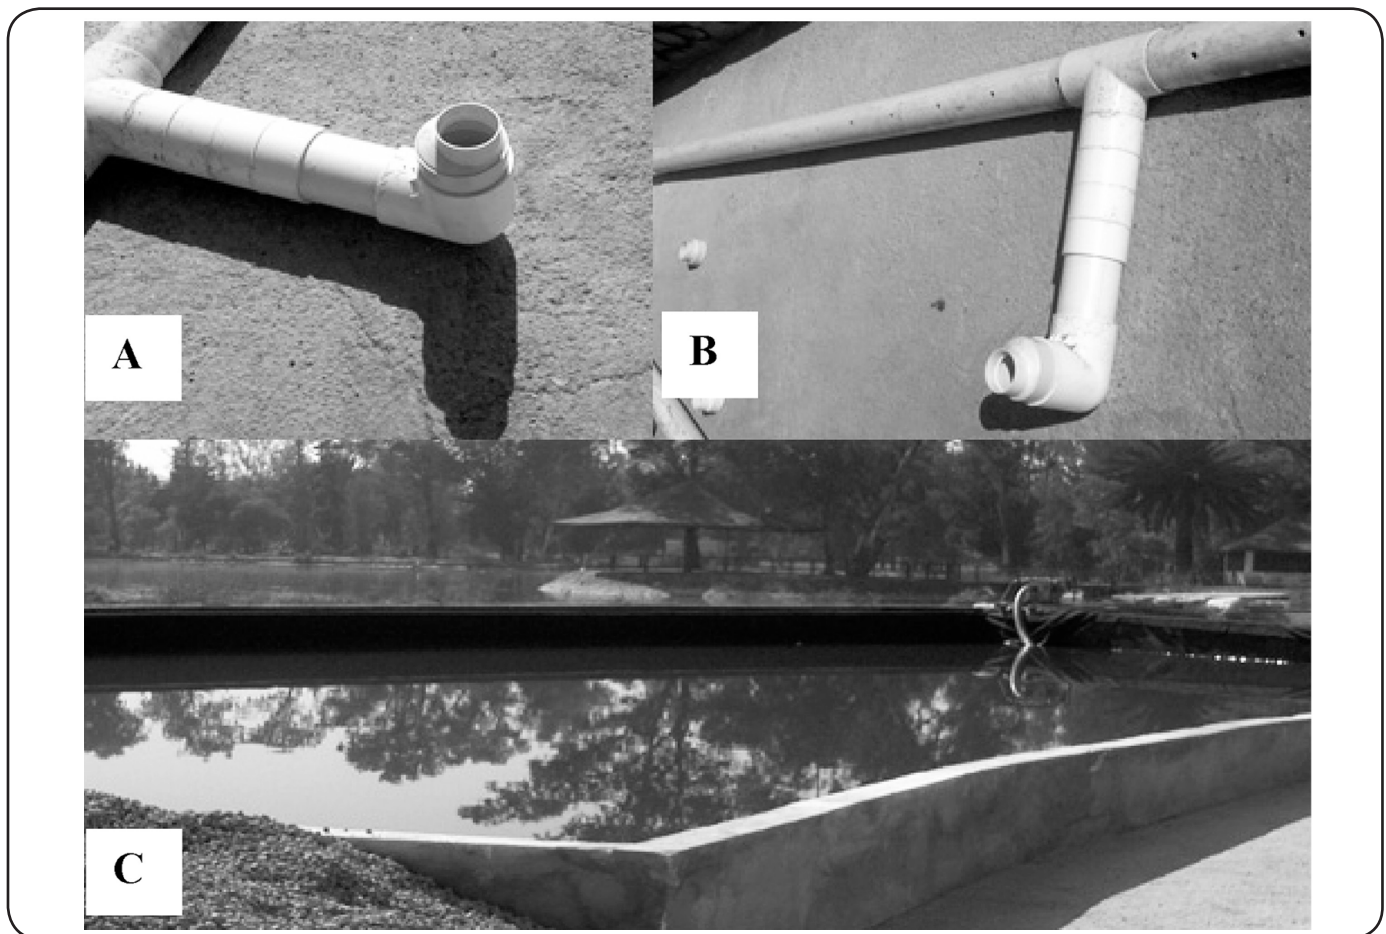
Construcción de infraestructura Interna: A y B) Instalación de las tuberías en el STHA. C) Pruebas hidráulicas en el HAFSS.
